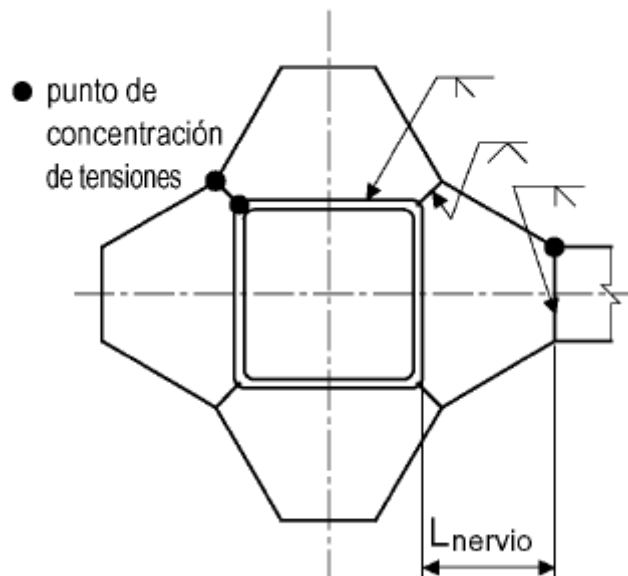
Recomendaciones de AIJ de soldadura para uniones viga-columna con diafragmas externos [15]
